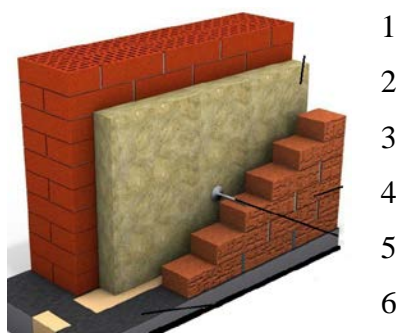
Конструктивна схема стіни: -1 стіна, 2 утеплювач, 3кріплення,
